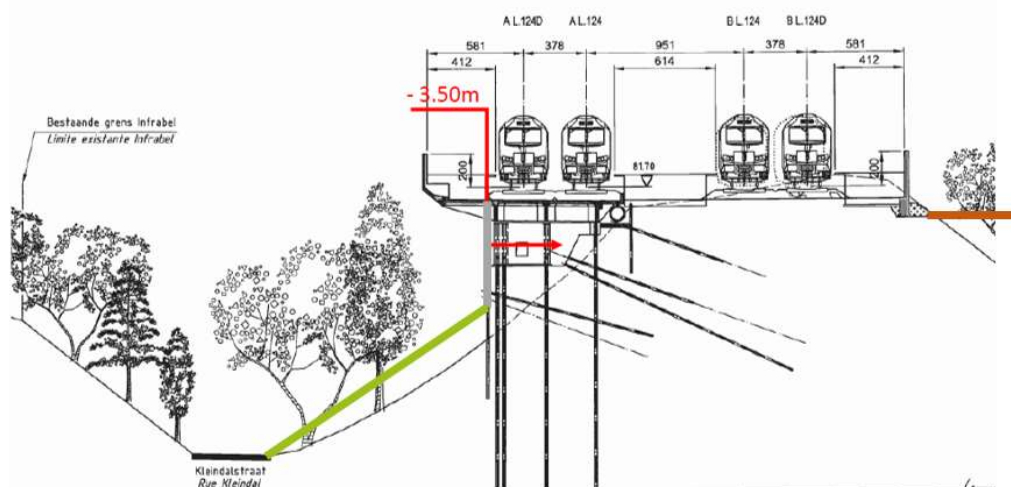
Kleindalstraat – alternatief 1 (bron: TUCrail + eigen bewerking)
